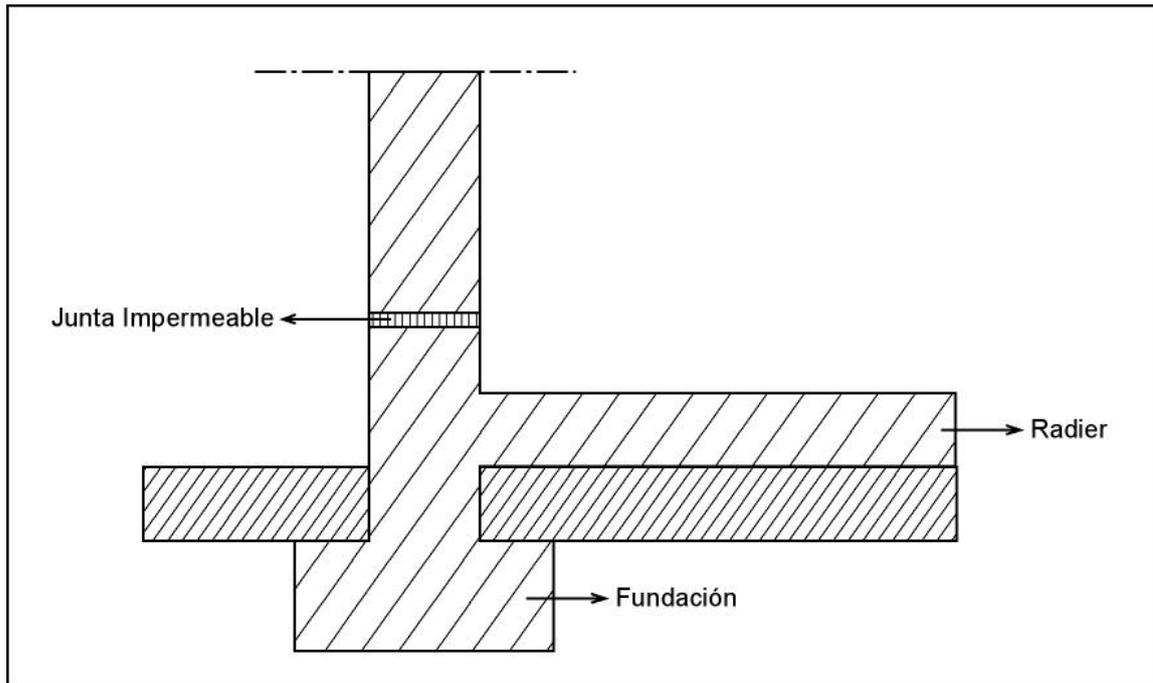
Corte transversal en un muro tratado con juntas impermeables.
